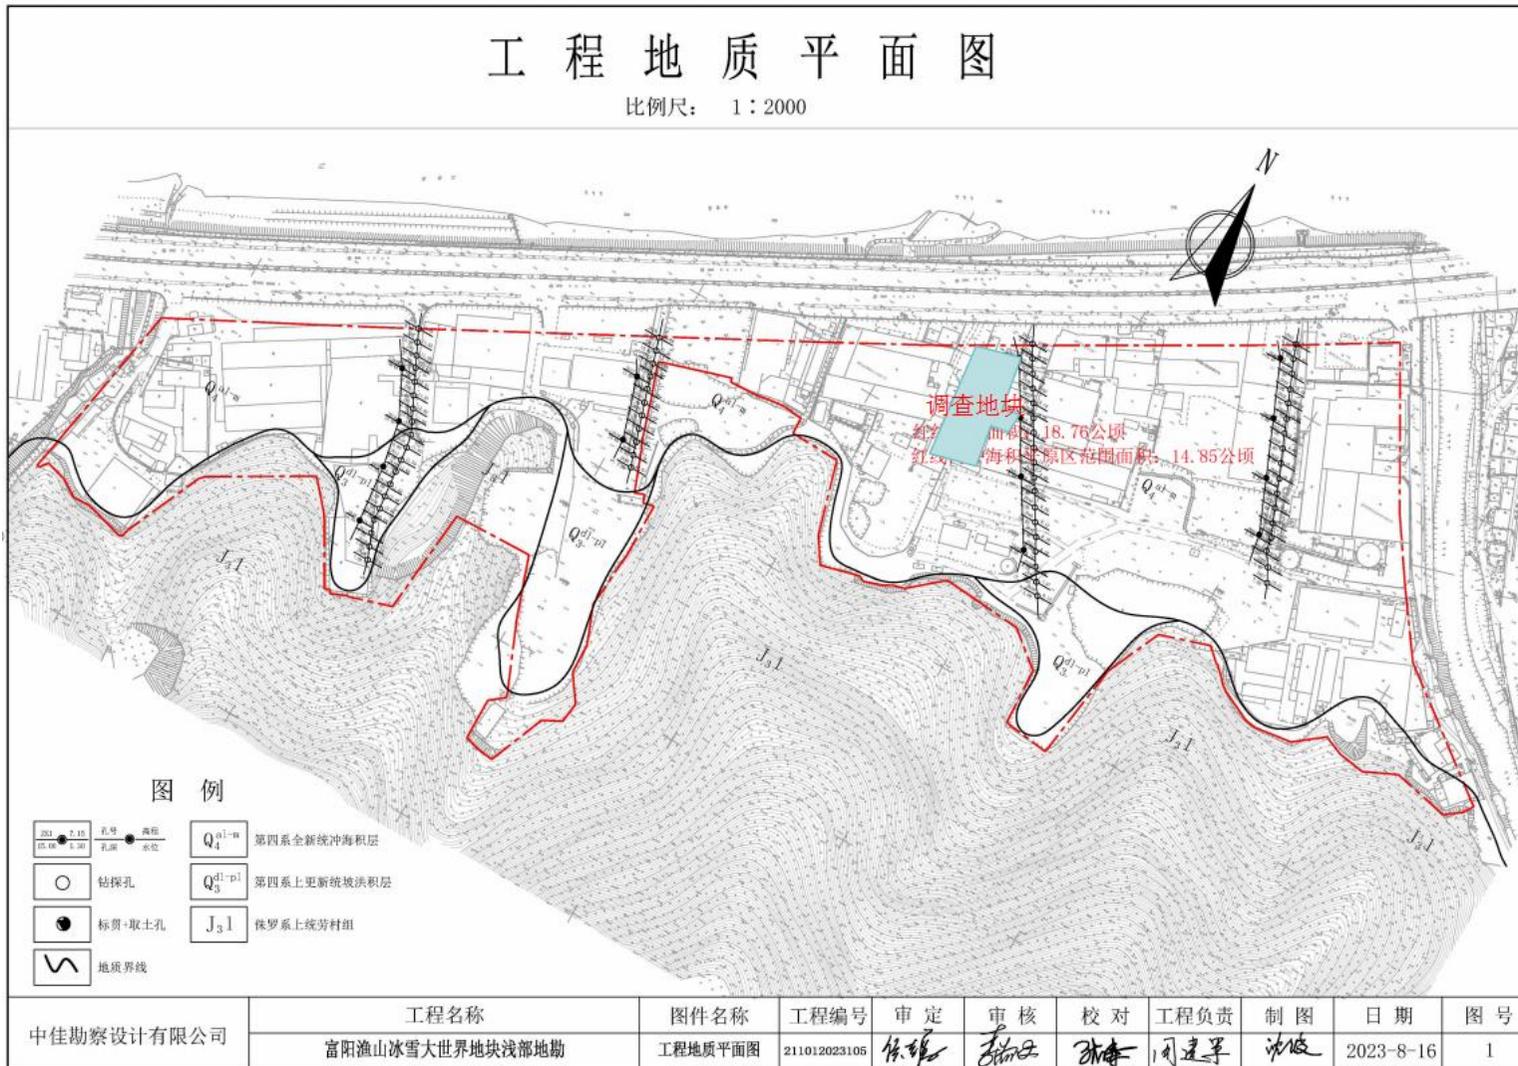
地勘报告的勘探点位平面布置图与本次调查地块的相对位置
